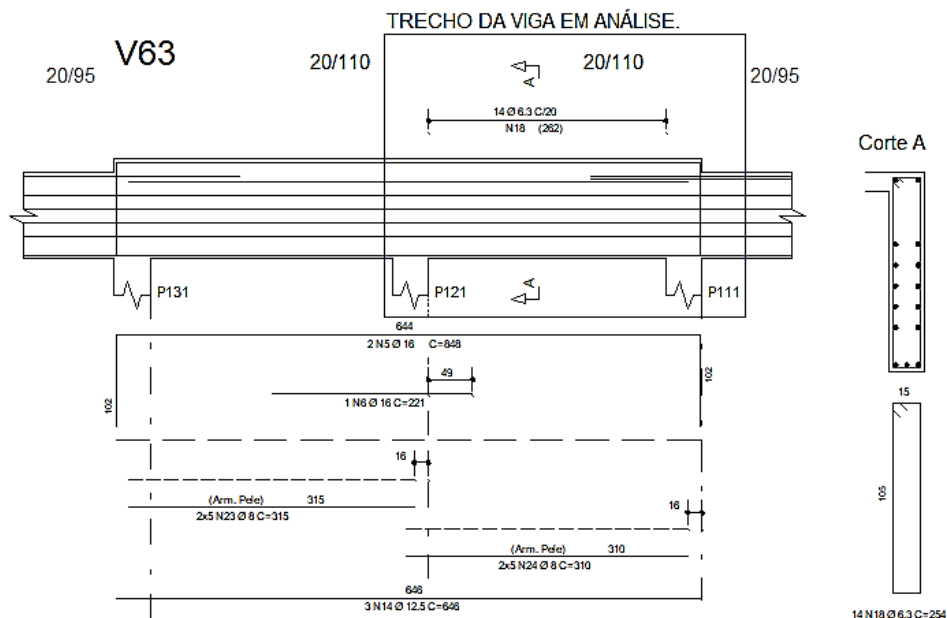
Detalhamento da viga de transição (V63) no trecho em análise.
